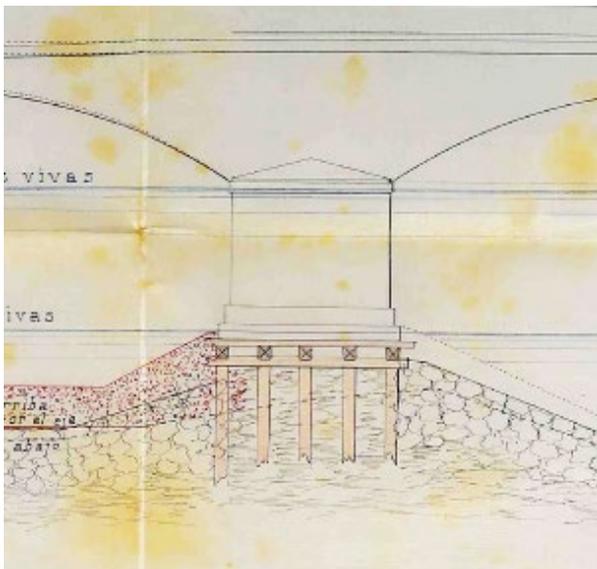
Detalle (típico) de emparrillado, tarima y zampeado tomado del proyecto de refuerzo de 1892
